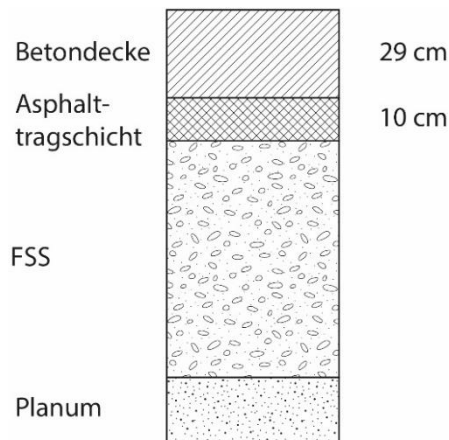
Strecke einer BAB mit 1 Jahr Liegedauer mit Betondecke auf ATS auf FSS
